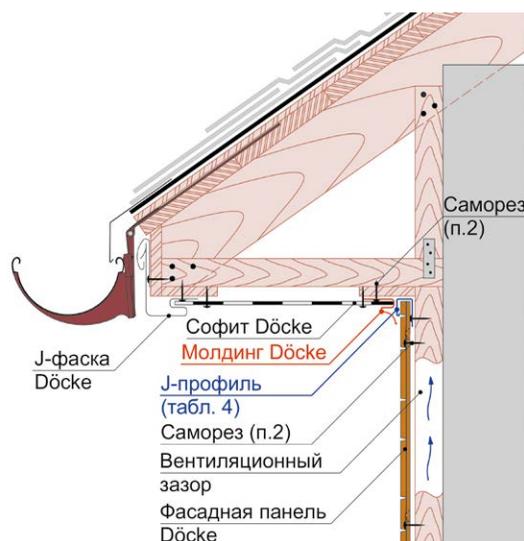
Примыкание фасадных панелей Döcke к карнизному свесу.
